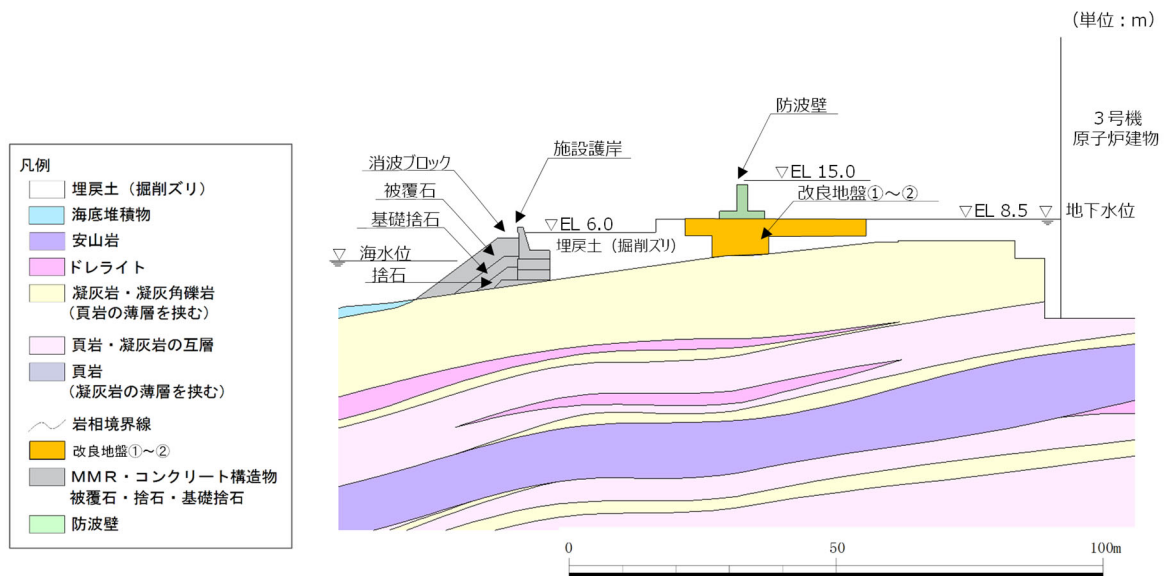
防波壁（逆 T 擁壁）の横断面図（③-③断面）
